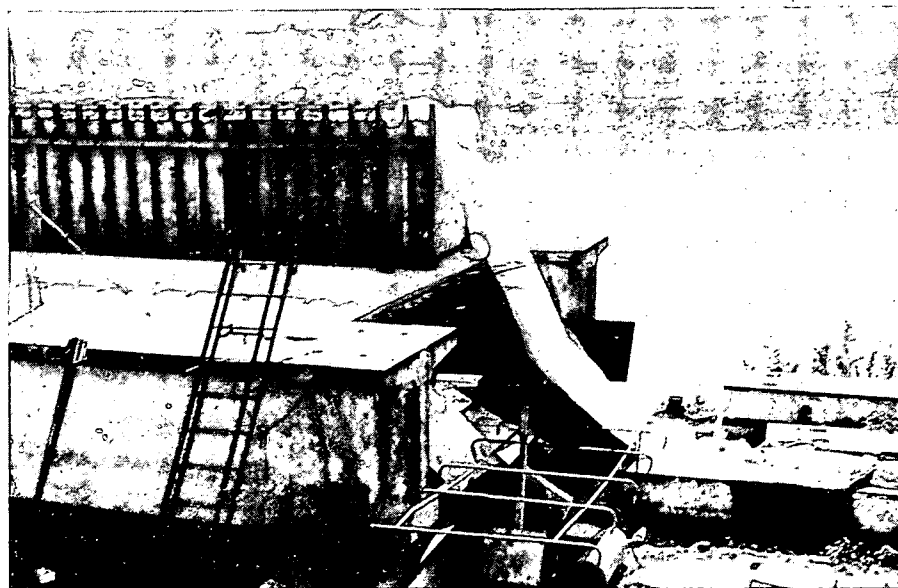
Dispositif d'essai d'un tablier de pont sans entretoise
